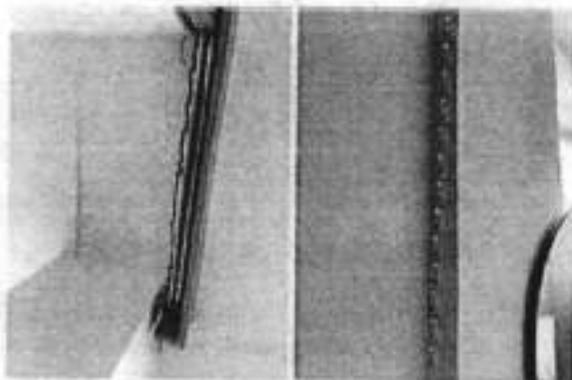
y 28. Fisuras en vértices entre placa de entepiso y muros perimetrales del apartamento 101 predio P1.
